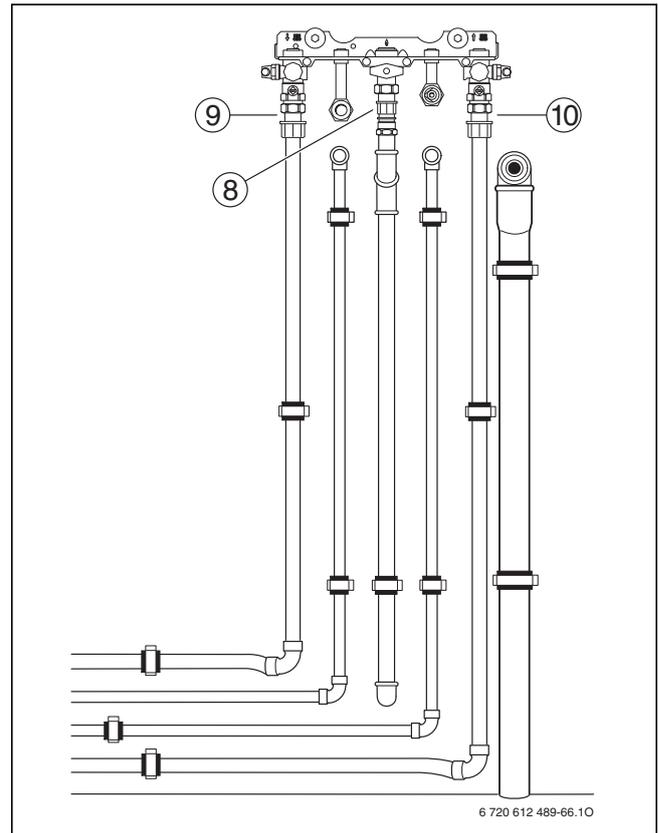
Bauseitige Aufputzverrohrung mit 60 mm Wandabstand
